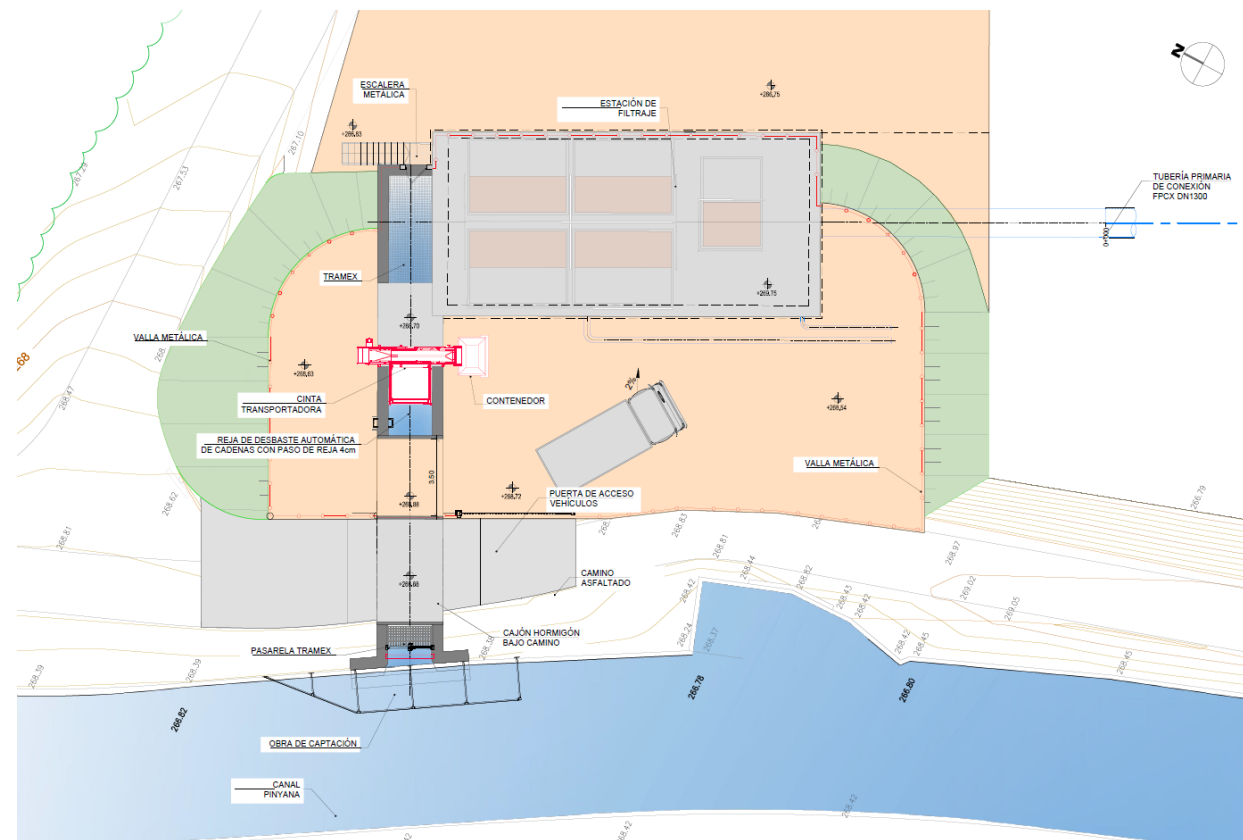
Planta general de la obra de captación y la estación de filtraje.
